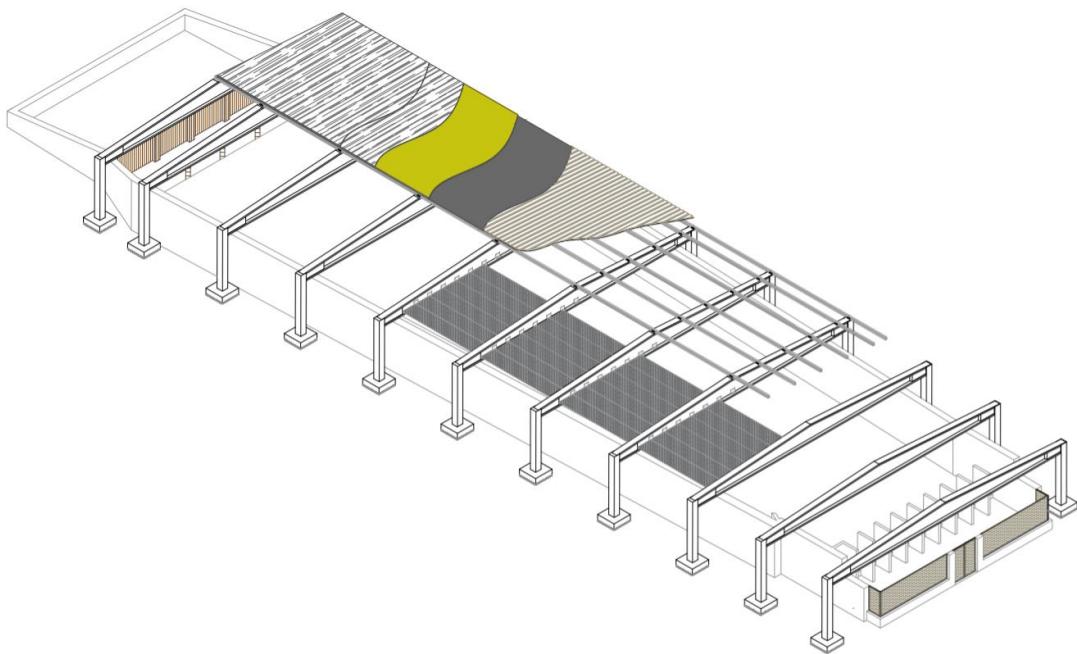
Imagen 3D de la galería de tiro con la estructura del tejado (Elaboración propia)
